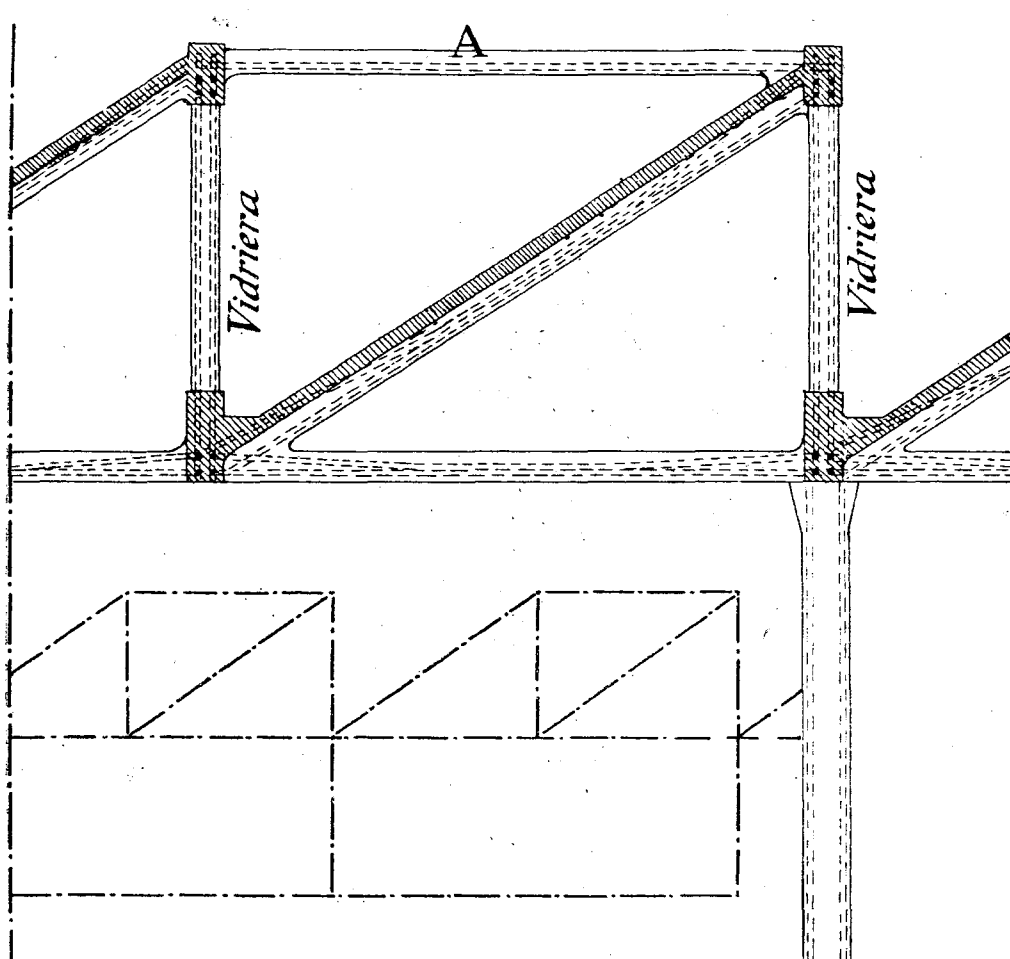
Cubierta de diente de sierra, con cuchillos de hormigón armado.
